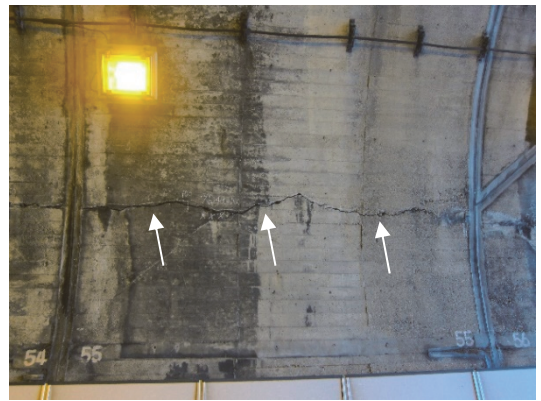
ひび割れ幅が極端に大きい例(矢印部分)
